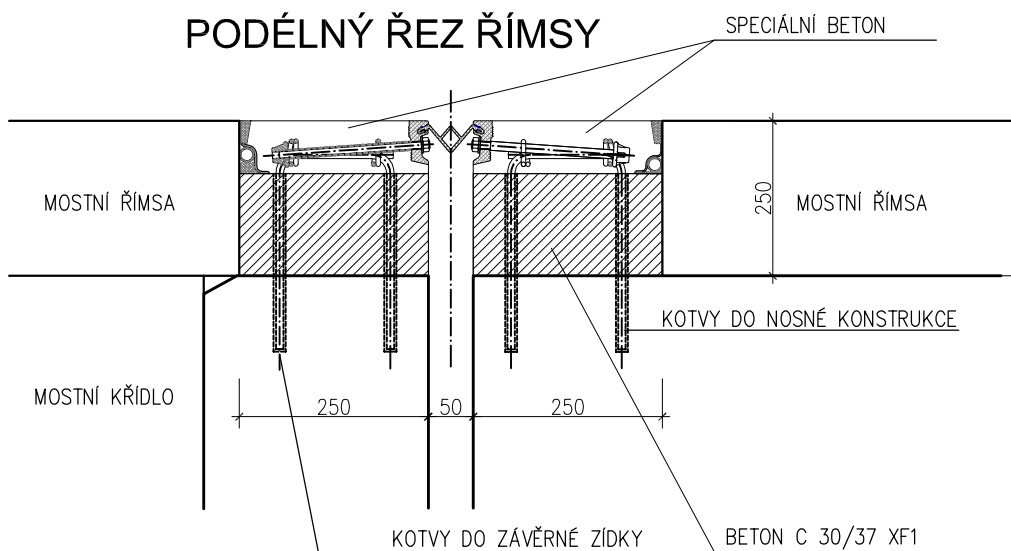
# DETAIL POVRCHOVÉHO ZÁVĚRU 1:10
